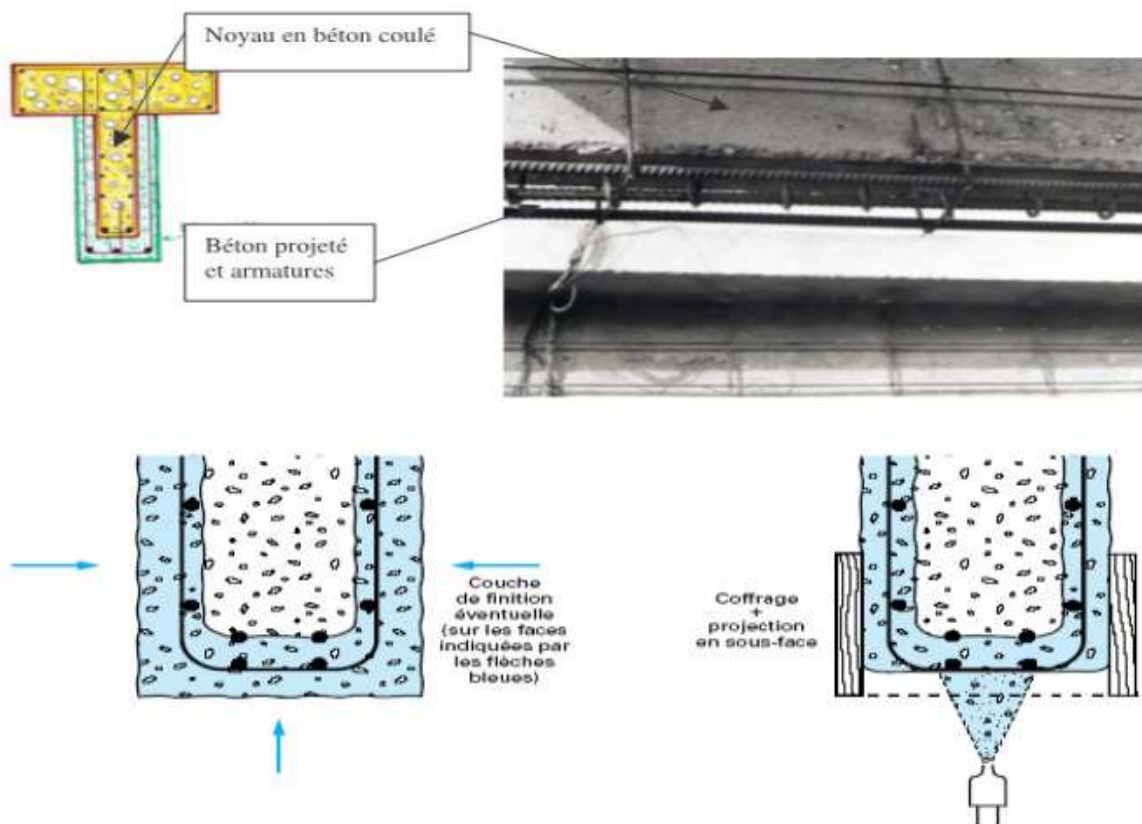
Renforcement de poutre par béton projeté [41]
